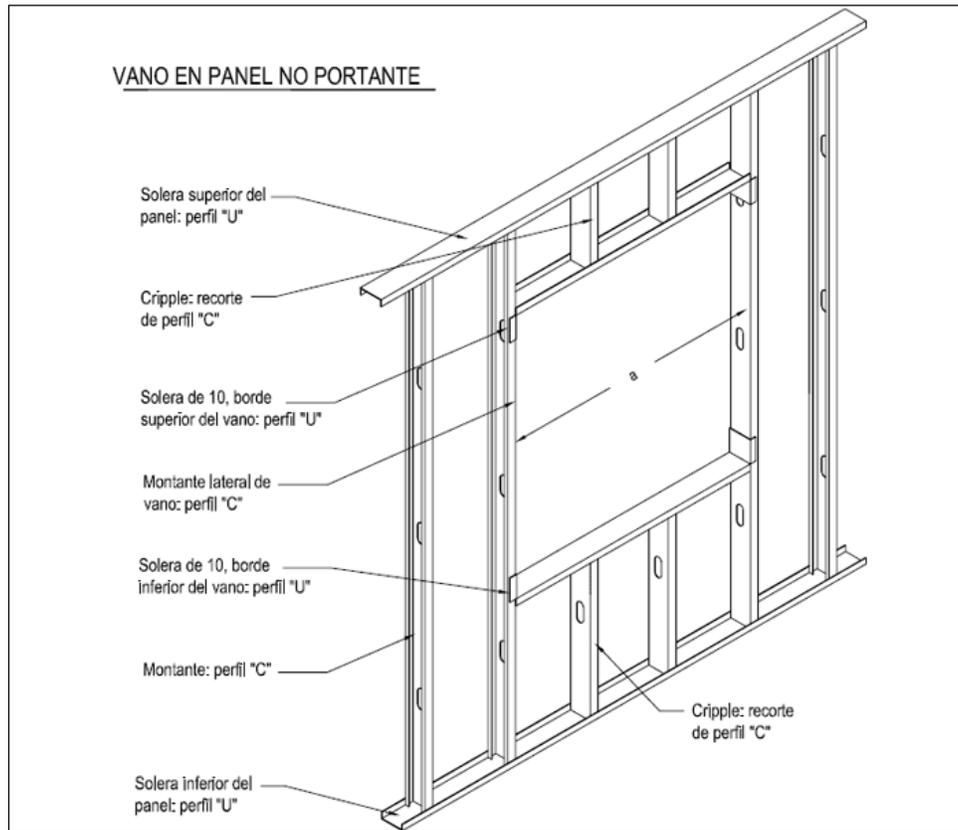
⁽¹⁰⁾. Estructura steel framing para paredes no portantes
